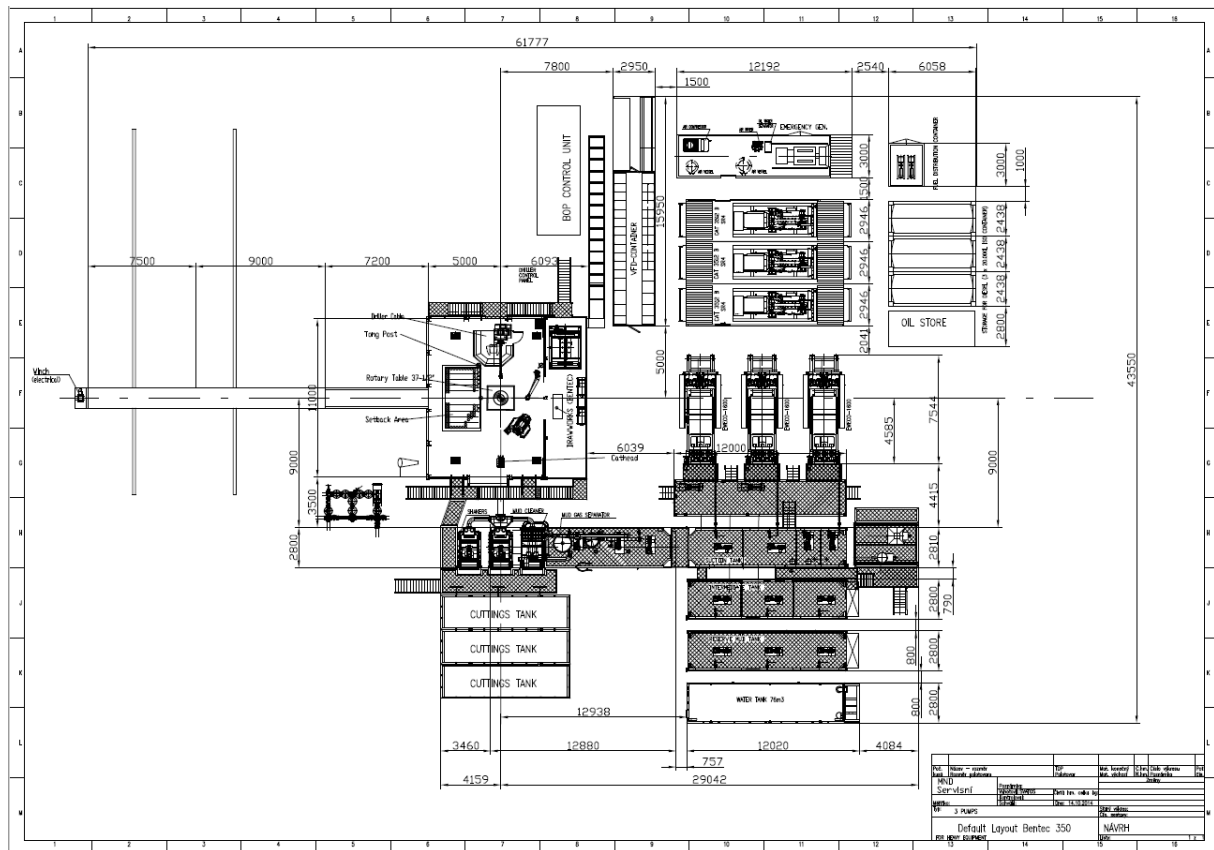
Plan d'implantation d'un RIG de type BENTEC 350
